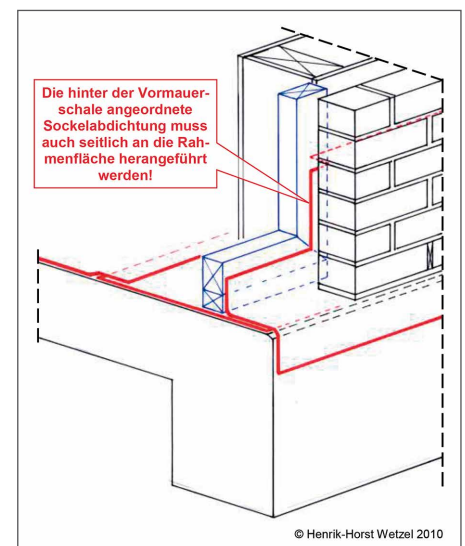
Fachgerechte Anordnung sämtlicher Abdichtungen
